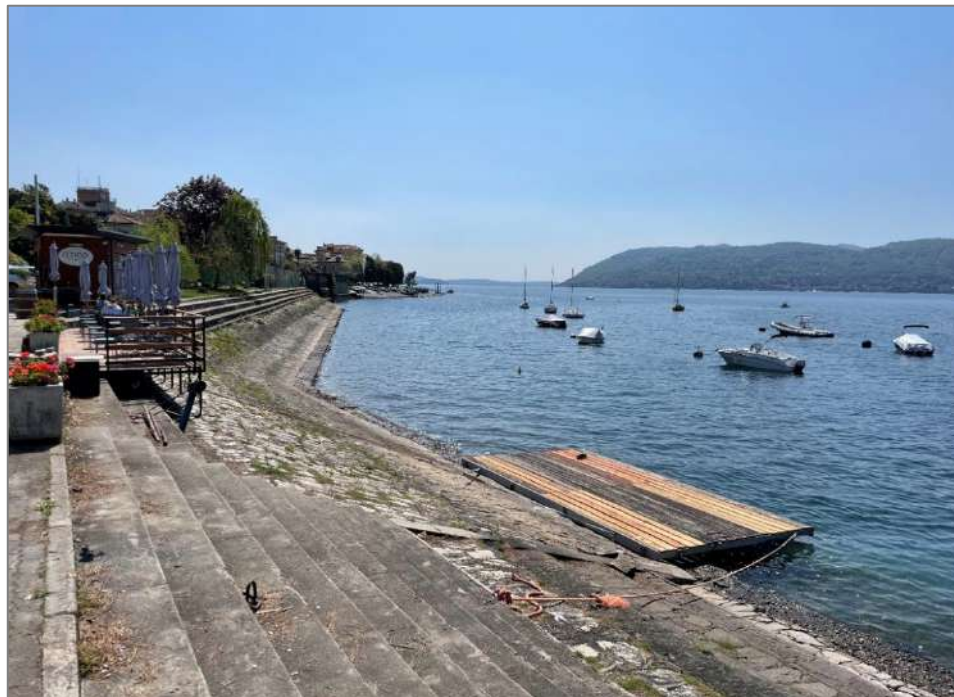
Lago Maggiore – Pallanza - Area di progetto, vista dall'alto – Stato di fatto
